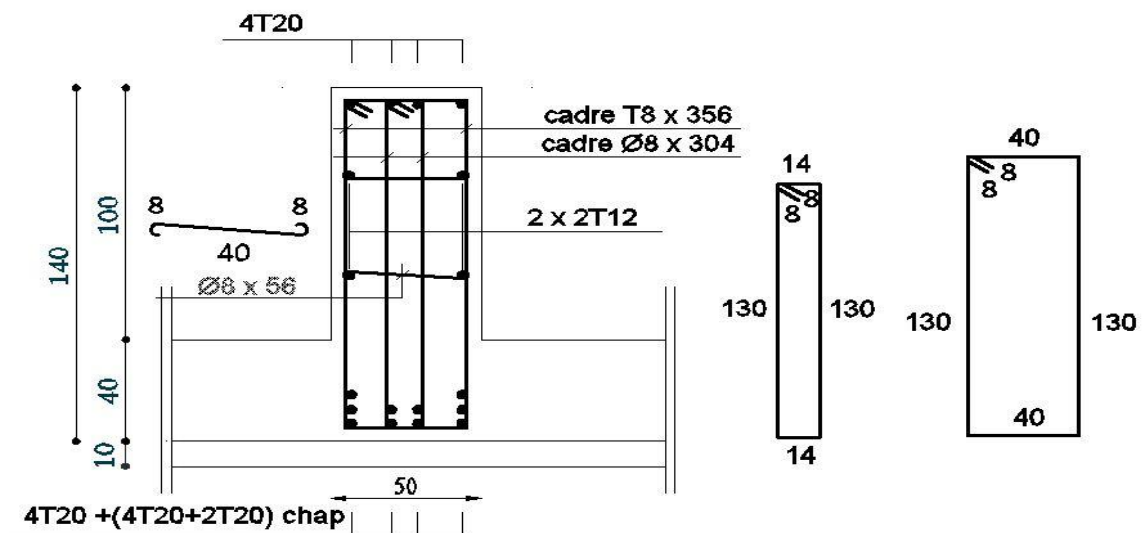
dessin de ferrailage d'une poutre principale en appuis.
